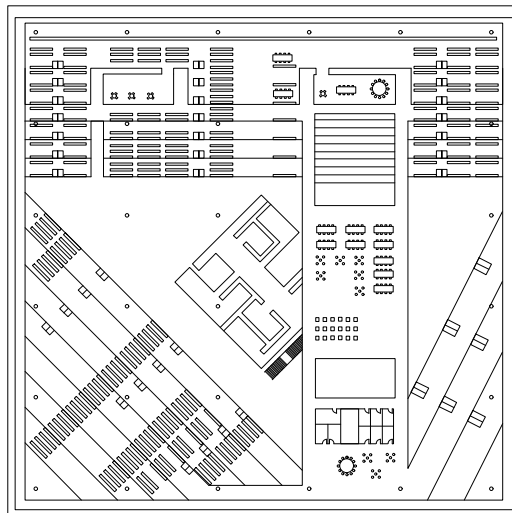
John Andrews, Gund Hall, Plan, 4. Obergeschoss
